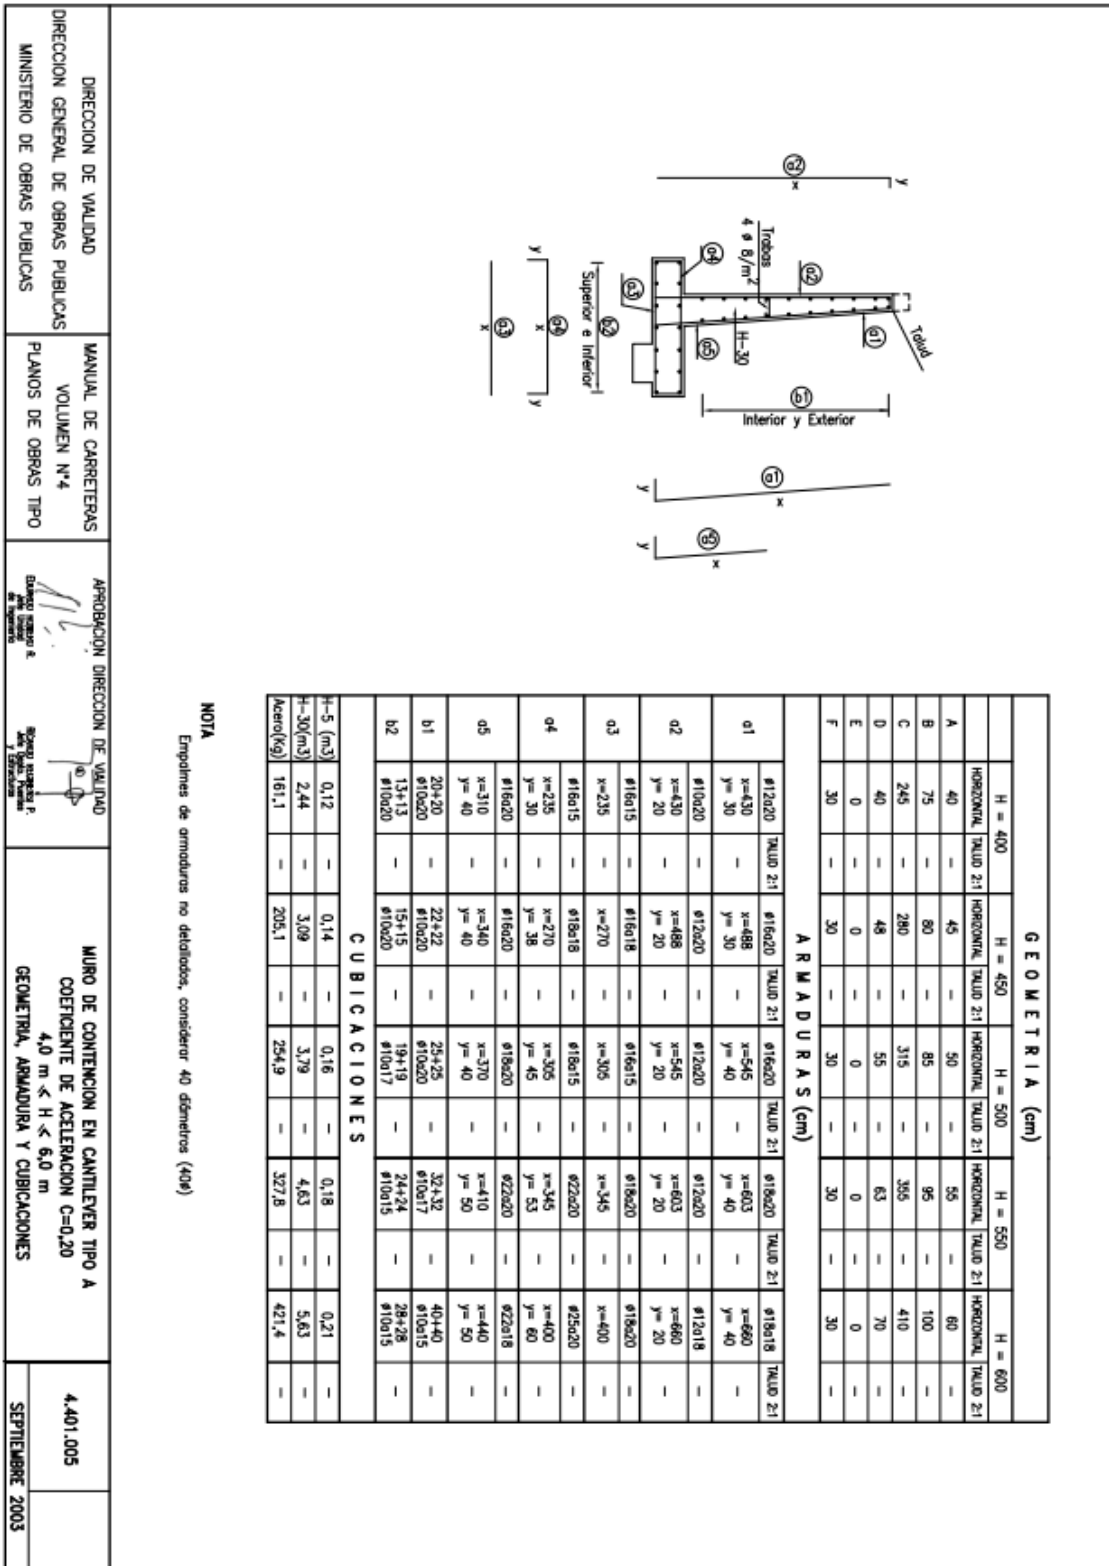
Plano de obra tipo para Muro de contención cantilever tipo A
